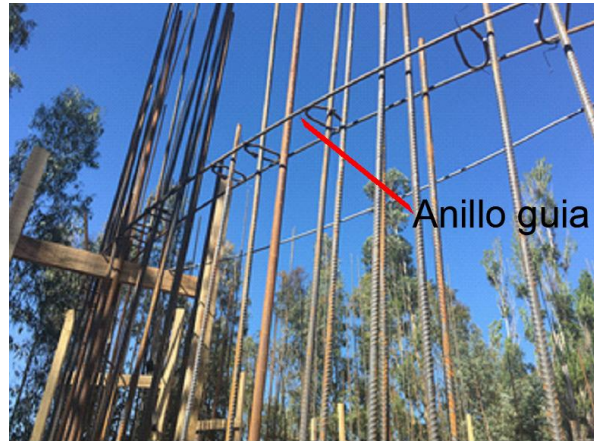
Distancia de colocación de armaduras en sistema de moldaje deslizante
